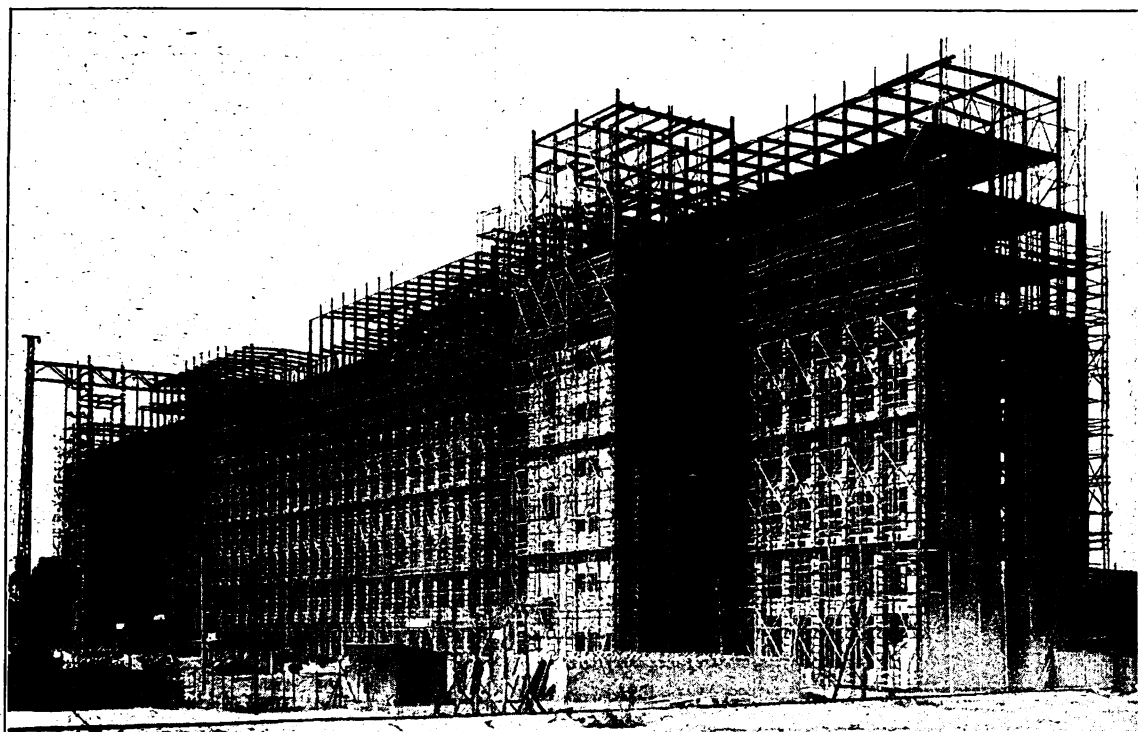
Uebliche Stangenrüstung an einem großen Berliner Neubau
